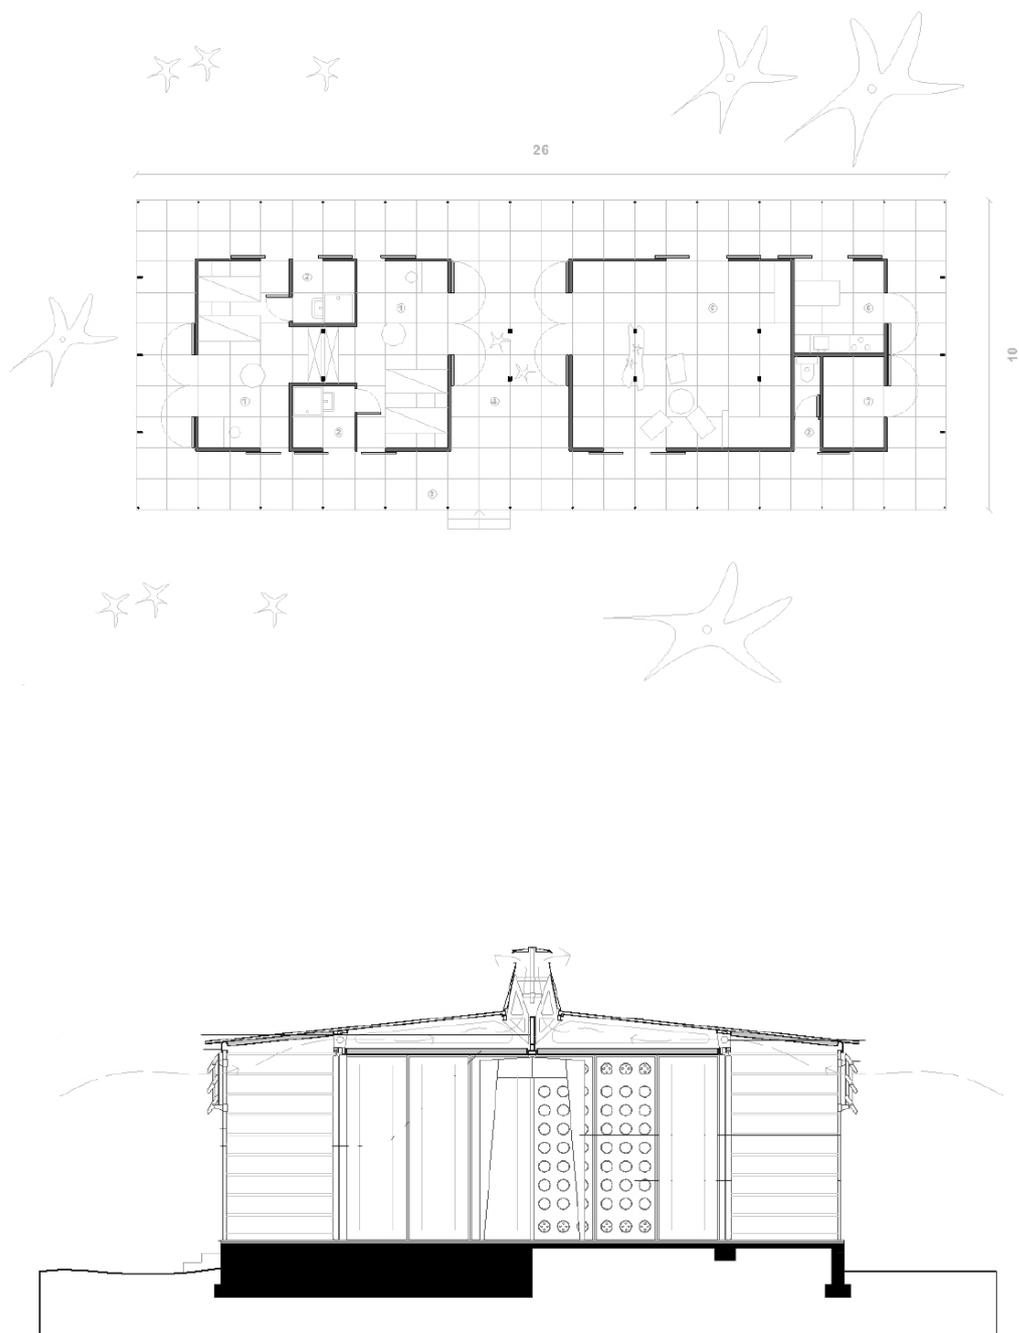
Jean Prouvé - *Casa Para os Trópicos, Niamey, Níger, 1949*. Planta e Corte Transversal.
